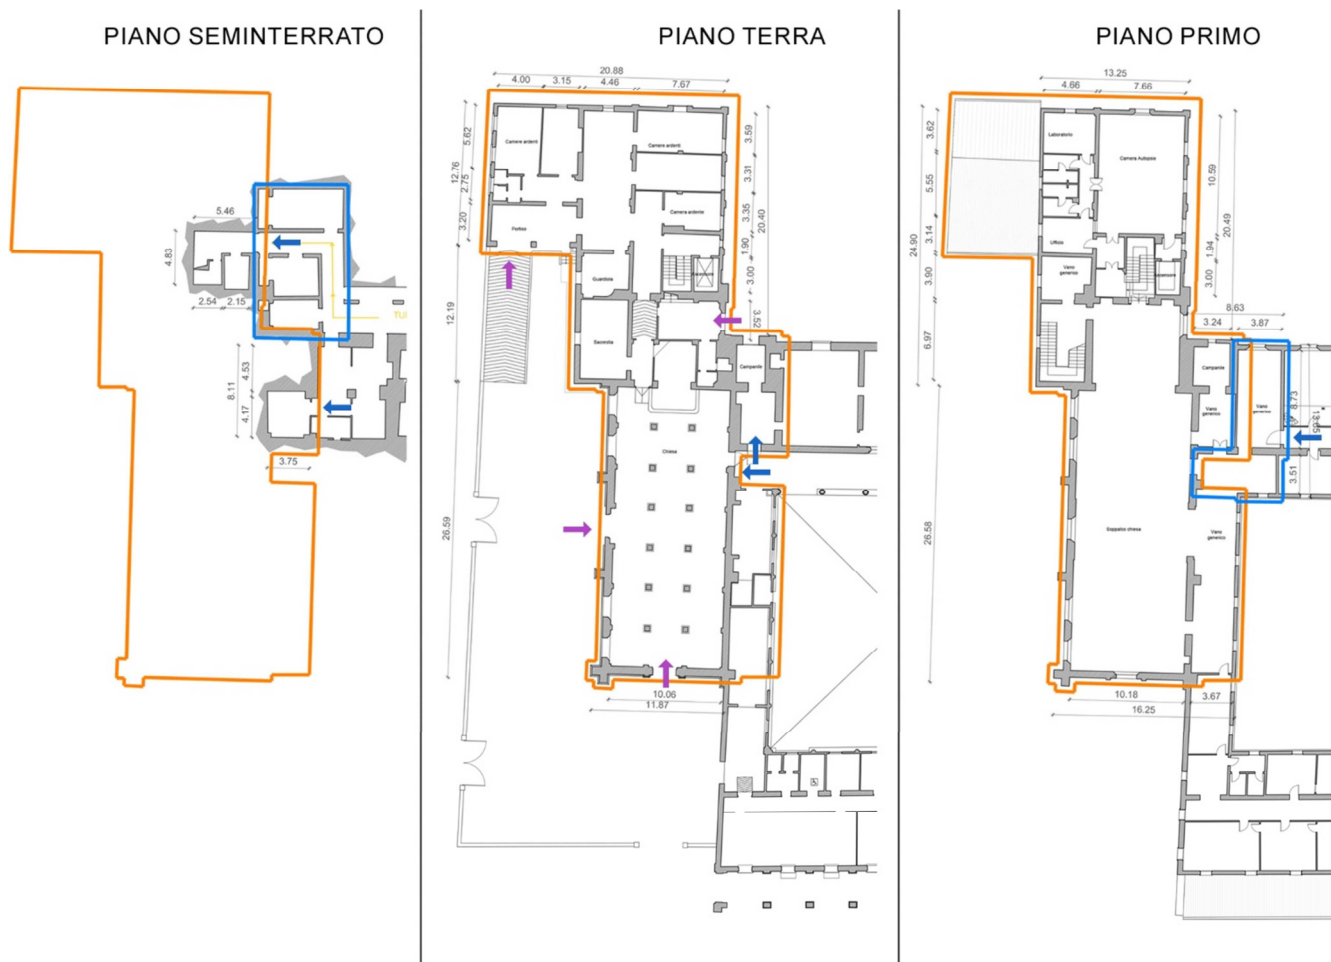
accessi alle aree- in blu accessi all'area dagli edifici adiacenti, in viola accessi alle aree dall'esterno
